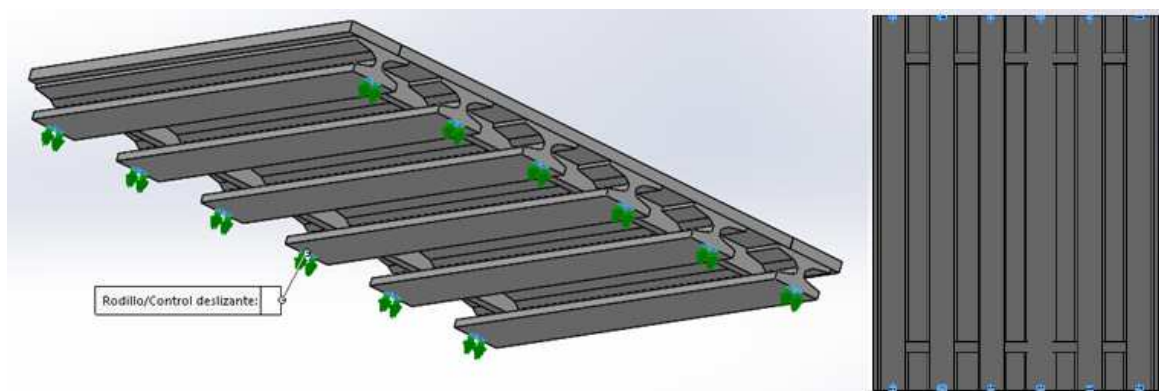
Ejemplo de la distribución de los apoyos de un puente de 6 vigas tipo C, SolidWorks.
